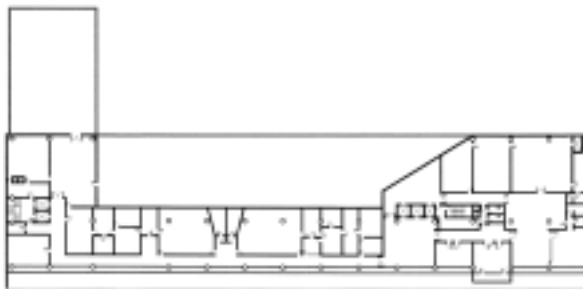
Palácio Iguazú . Centro Cívico de Curitiba . Planta 3 pavimento
